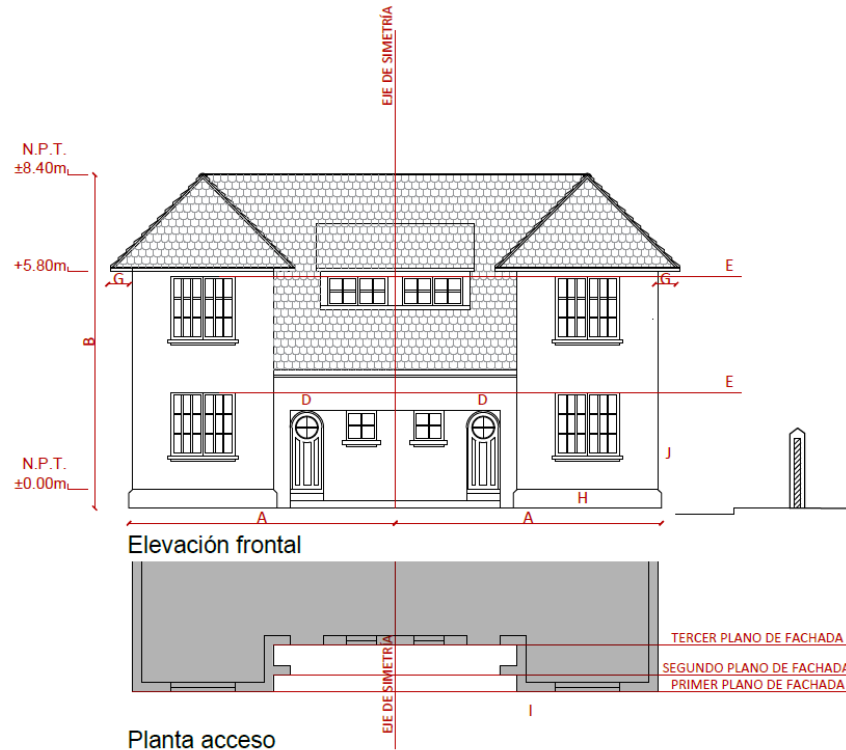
Elevación frontal de la tipología 2.3. Fuente: Elaboración propia.
